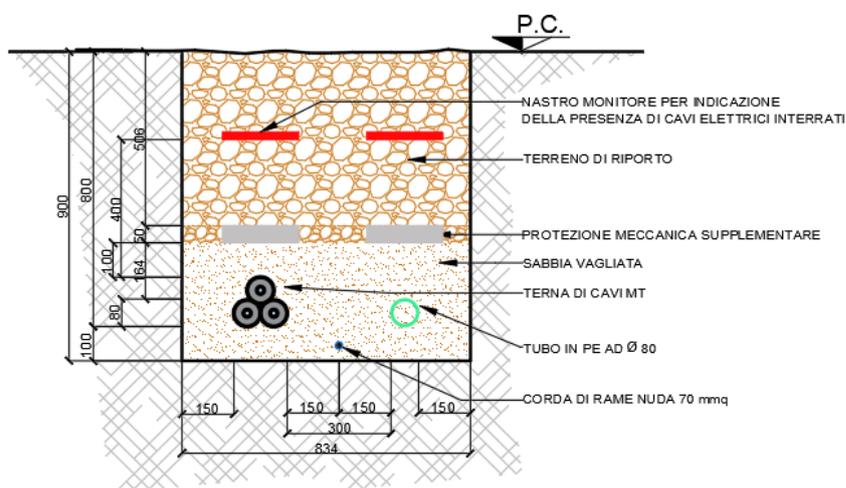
Sezione scavi tipo posa cavidotti MT
